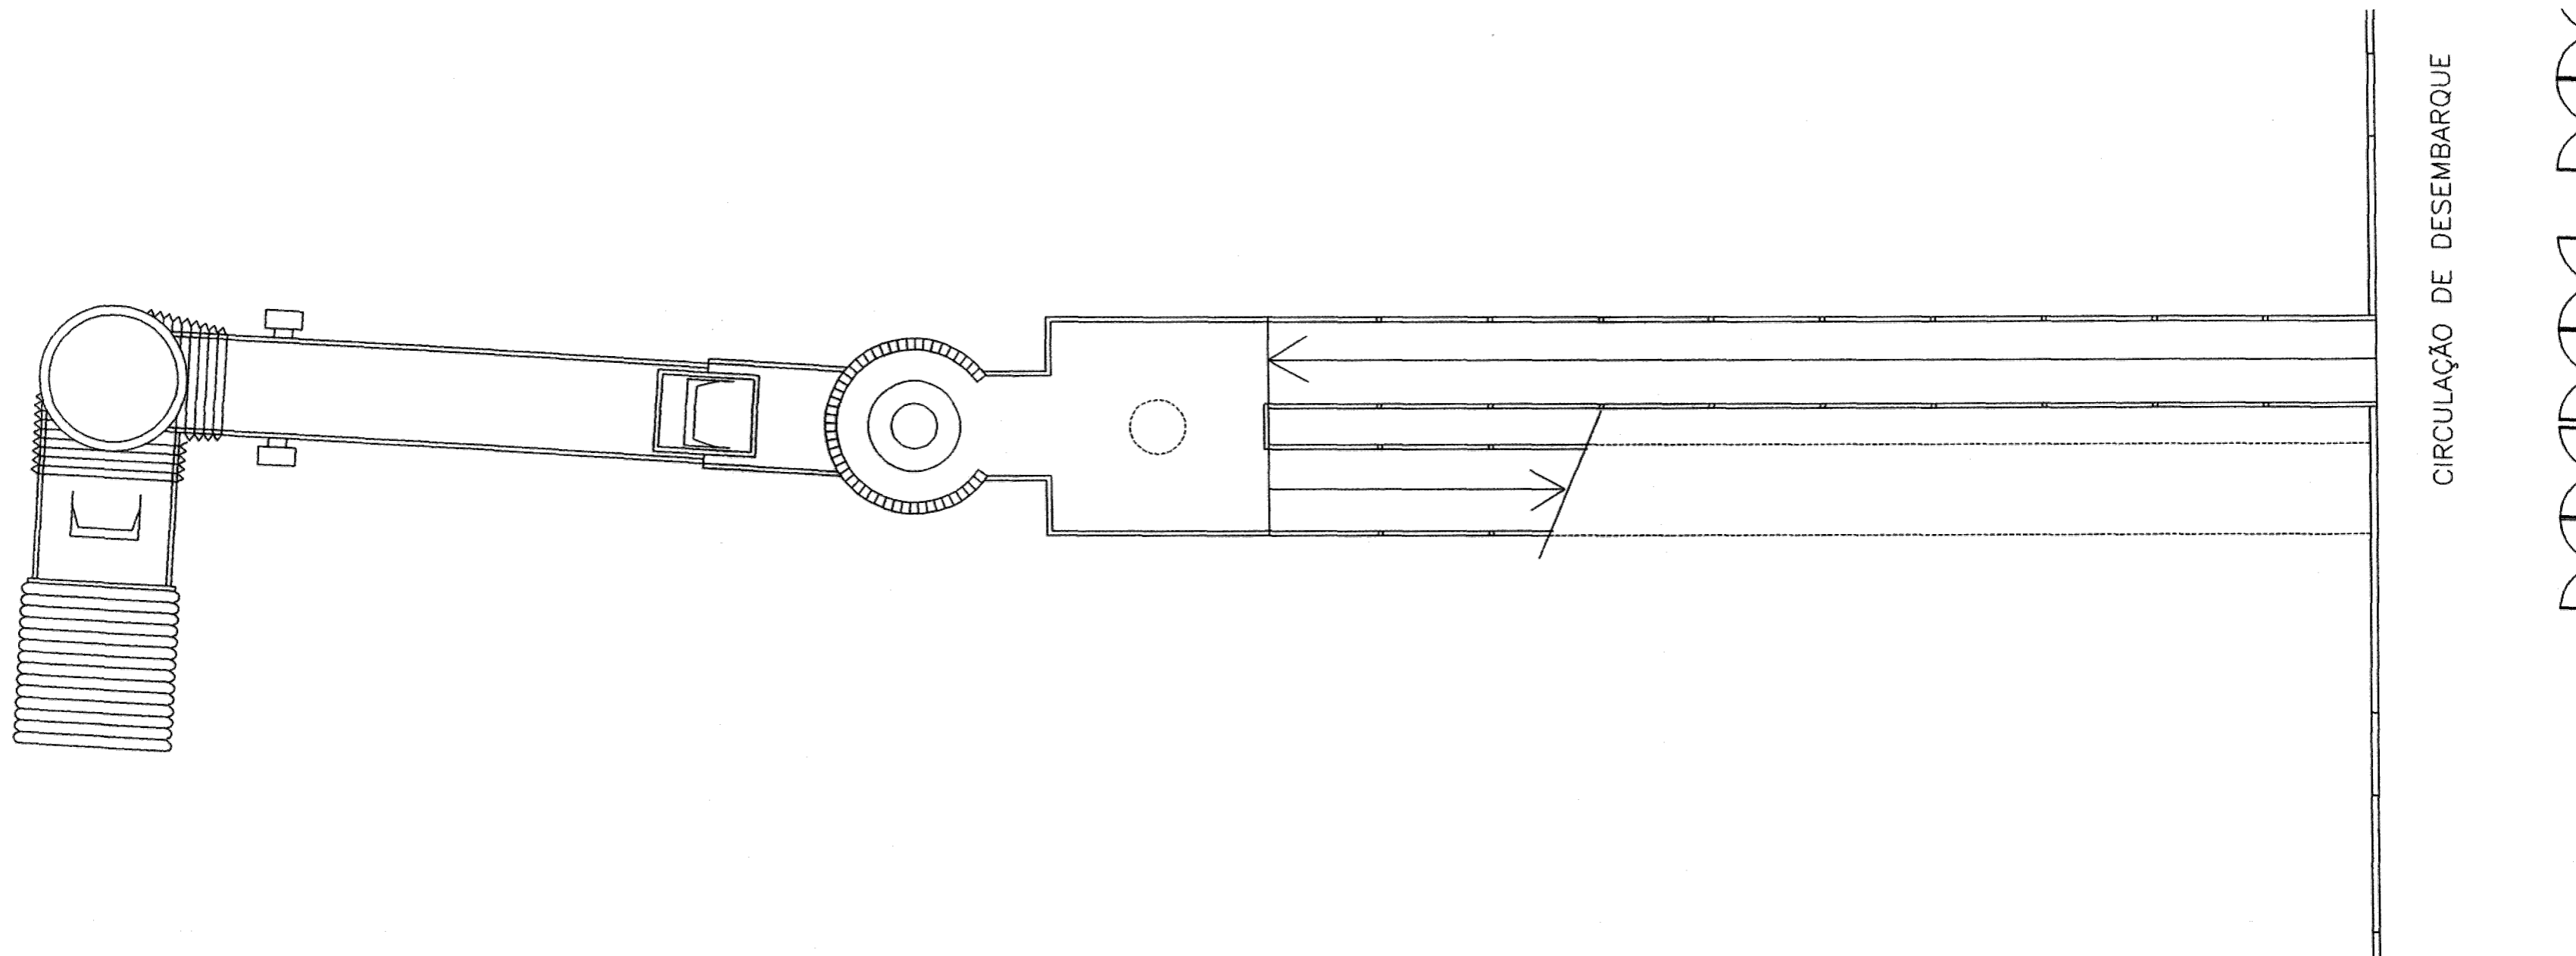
Situação de Projeto do Ponto P3 - Planta Baixa da Área de Interface entre a Edificação e a Aeronave
